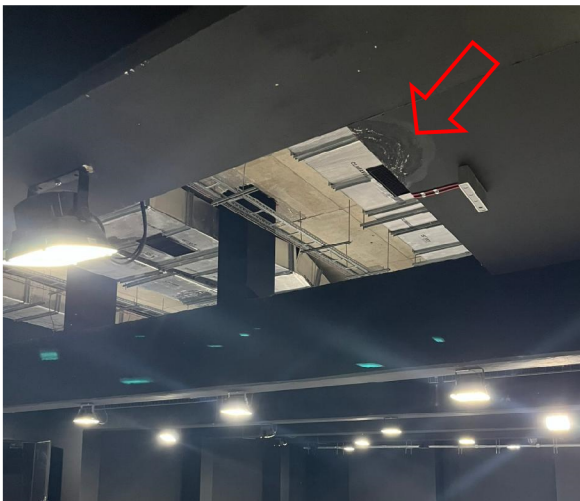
Widok konstrukcji stropodachu z podwieszoną do niego wentylacją.
